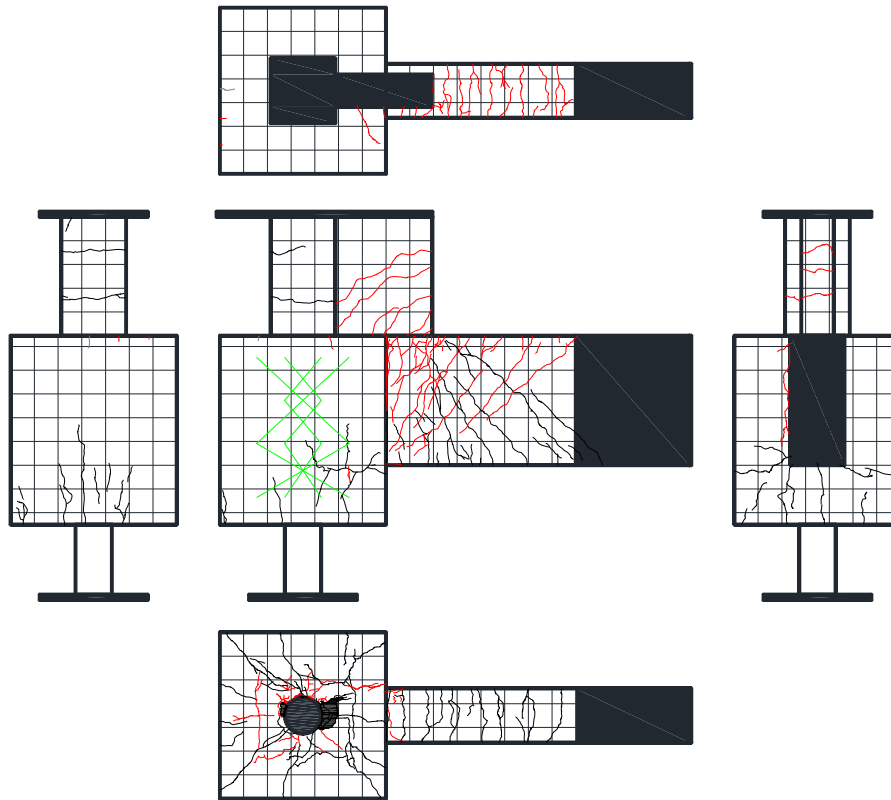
試験体 DR-2 ひび割れ状況 (8Cycle)
